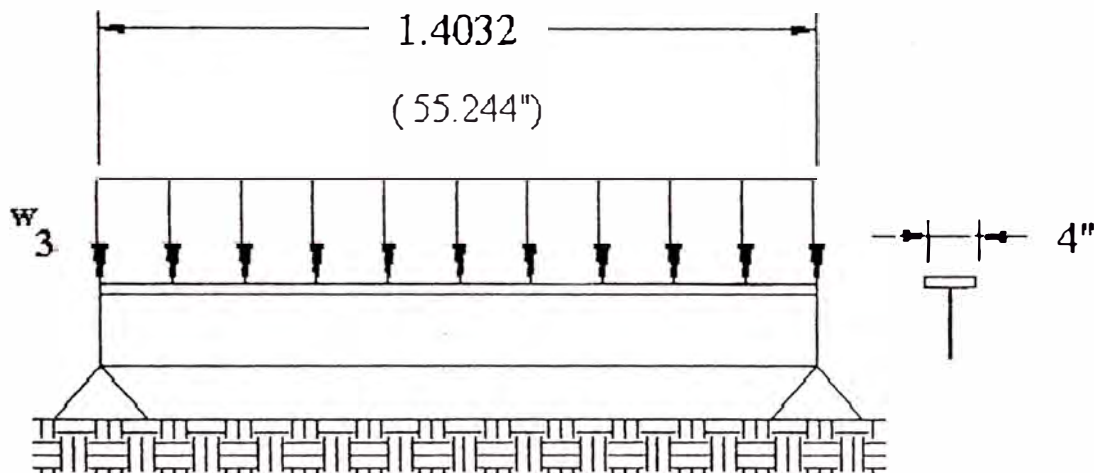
VIGA SIMPLEMENTE APOYADA
